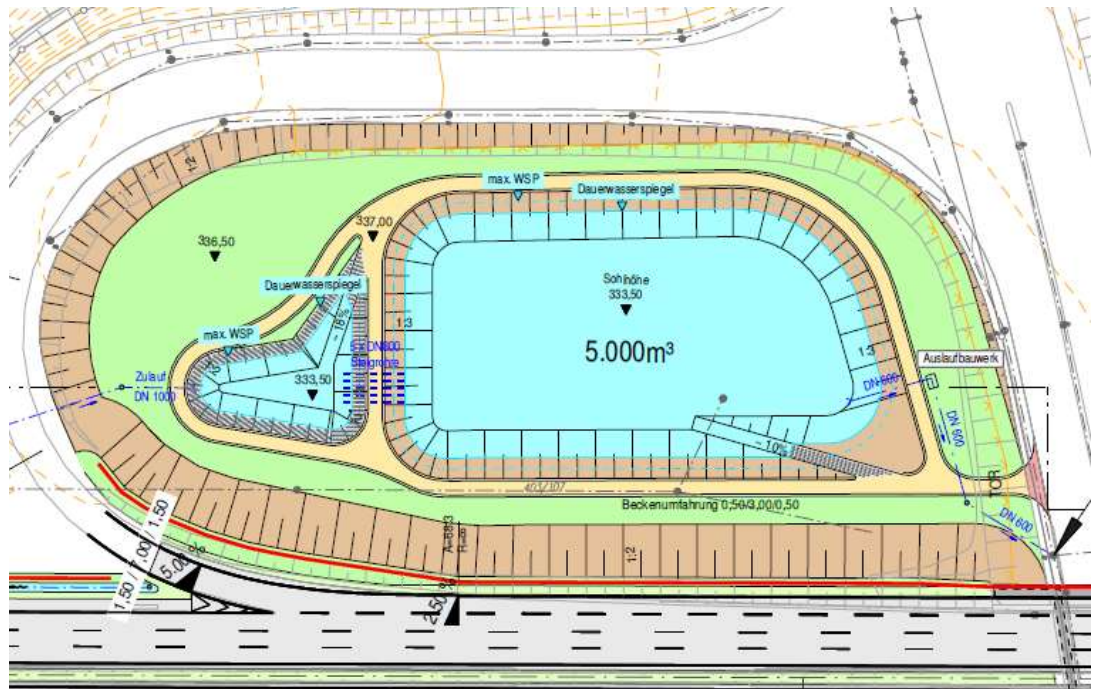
Darstellung des ursprünglich geplanten Regenrückhaltebeckens RRB 3
